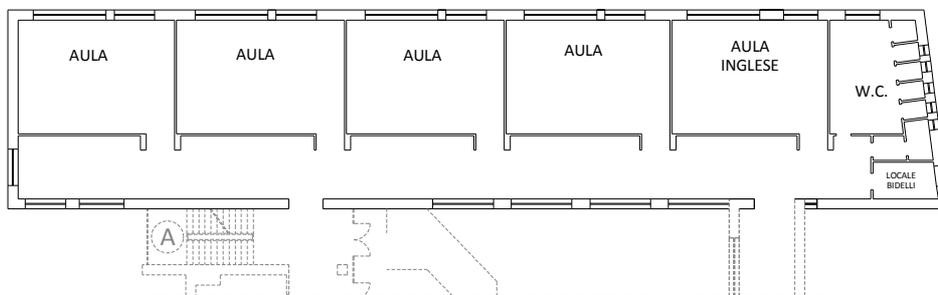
5: Pianta piano terra (blocco aule 2).
